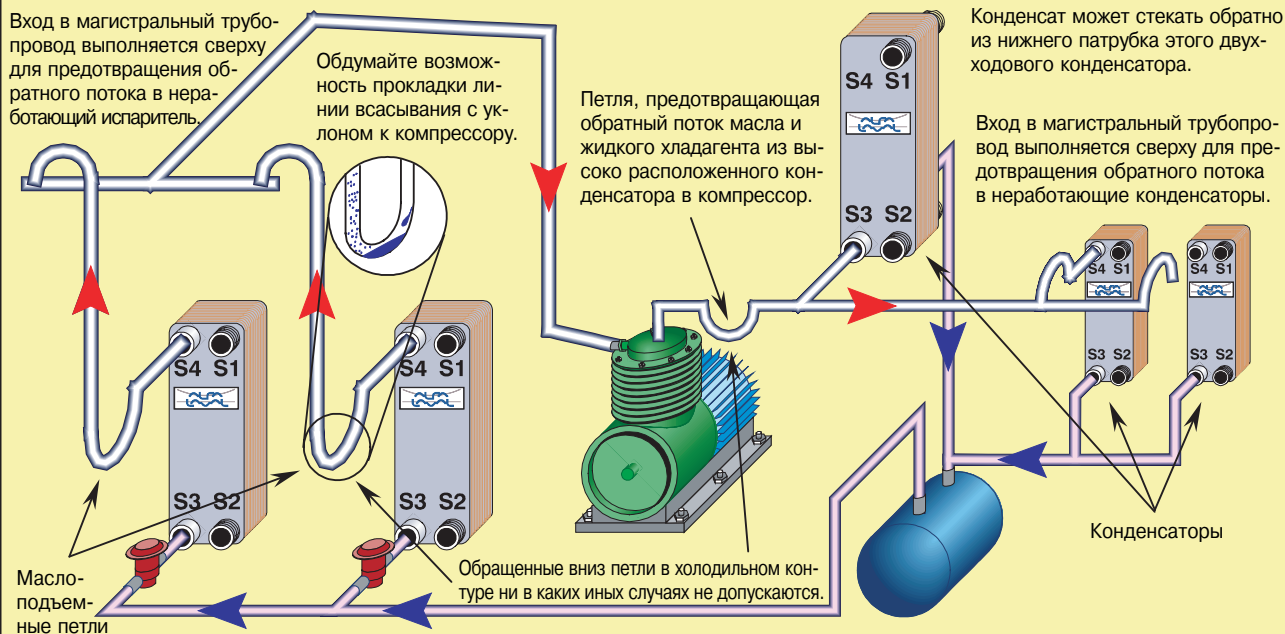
Линии пара испаритель - компрессор - конденсатор
